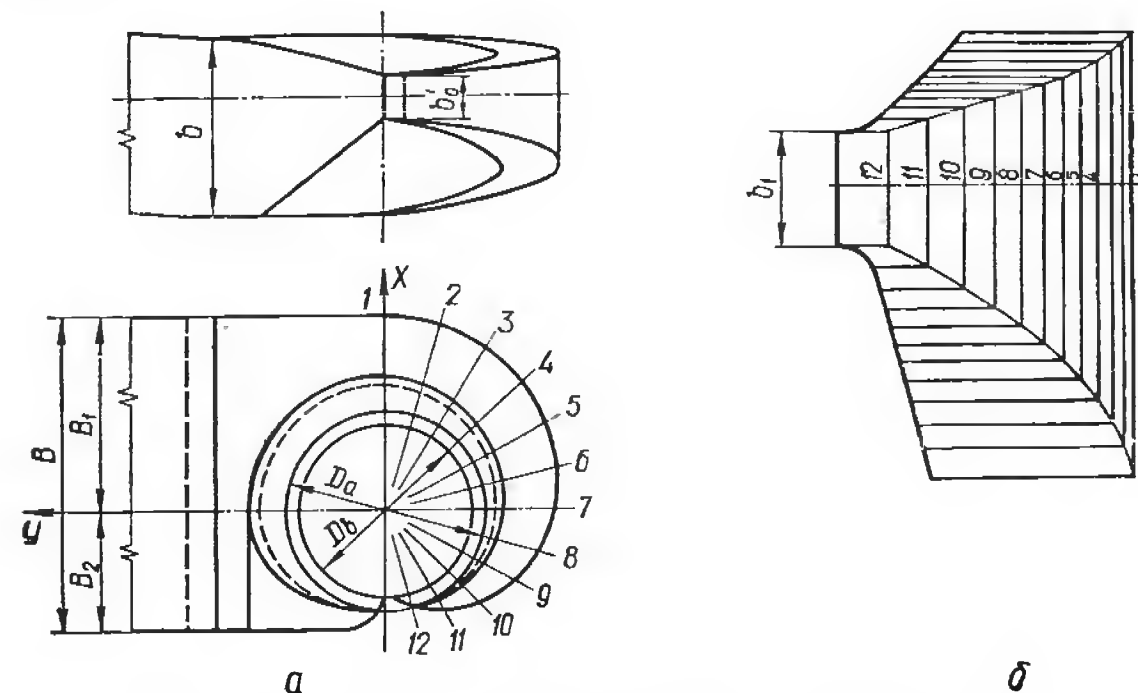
Теоретический чертеж бетонной спиральной камеры: а — вертикальная проекция и план камеры; б — радиальные сечения камеры.
